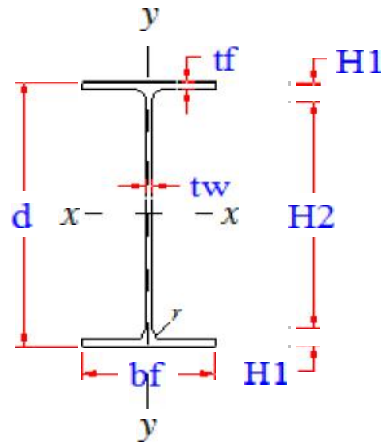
Penampang Kolom Baja (Profil Kingcross)
